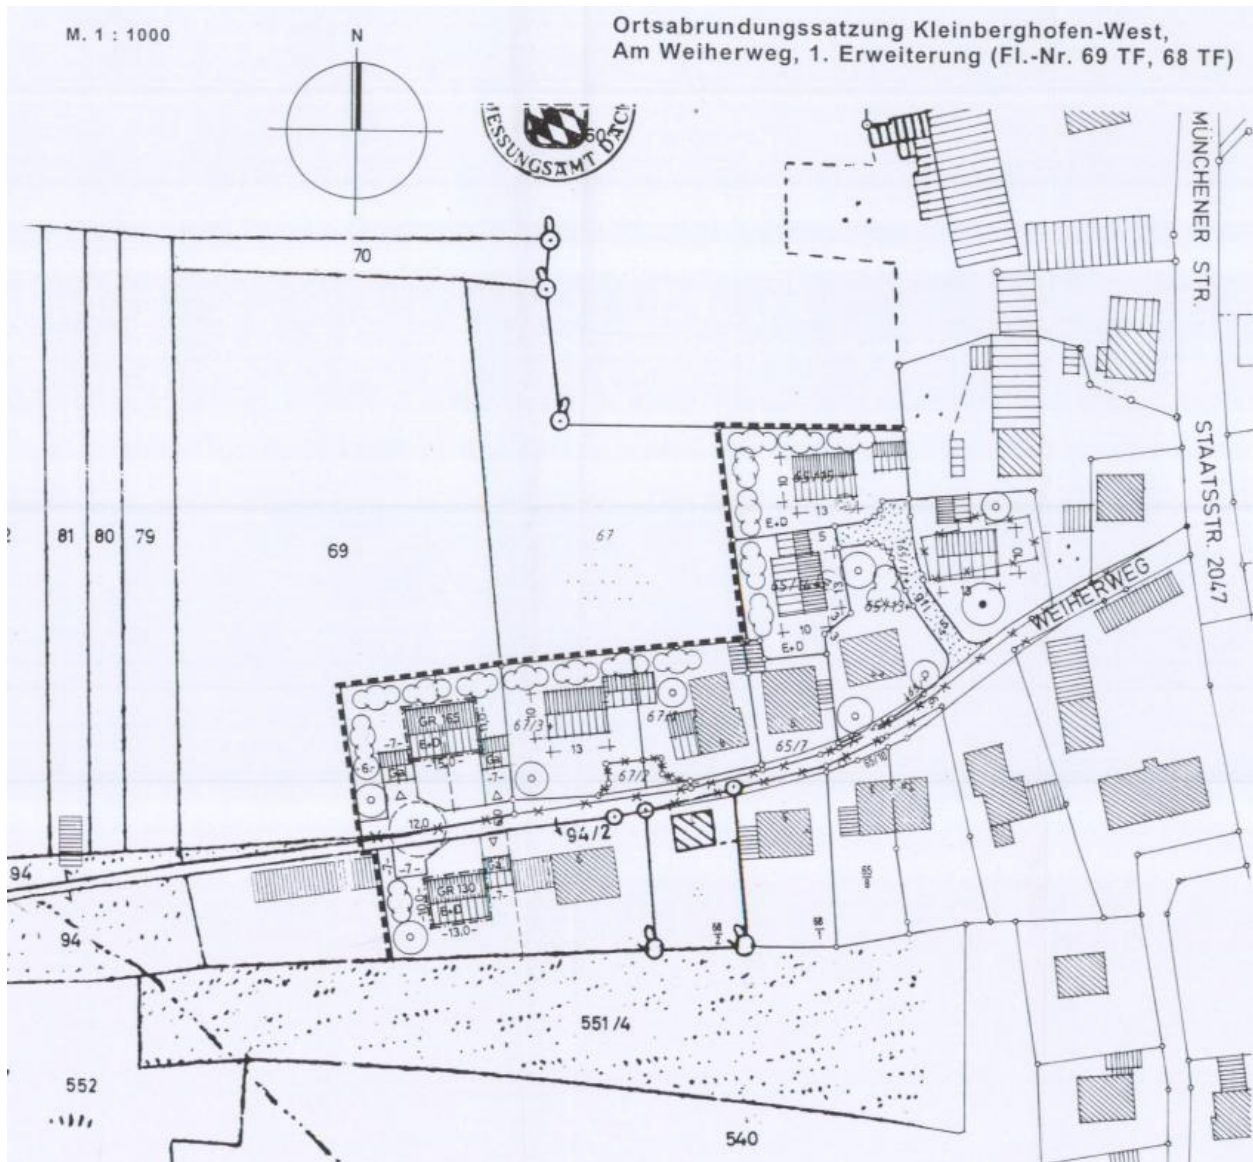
Bebauungsplan „Kleinberghofen West am Weiherweg“ mit Erweiterung, o. M.
